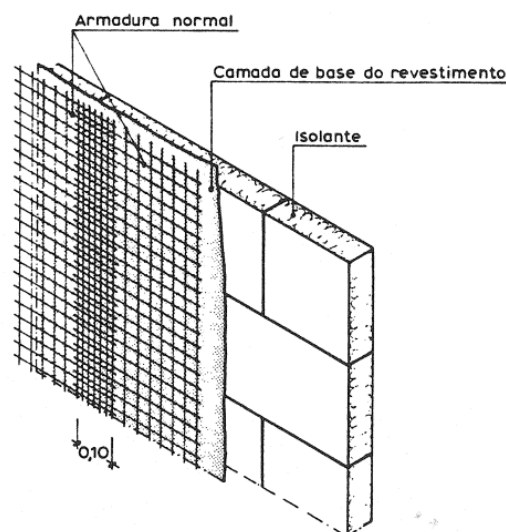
Sobreposição dos bordos de faixas contíguas de armadura [2]
